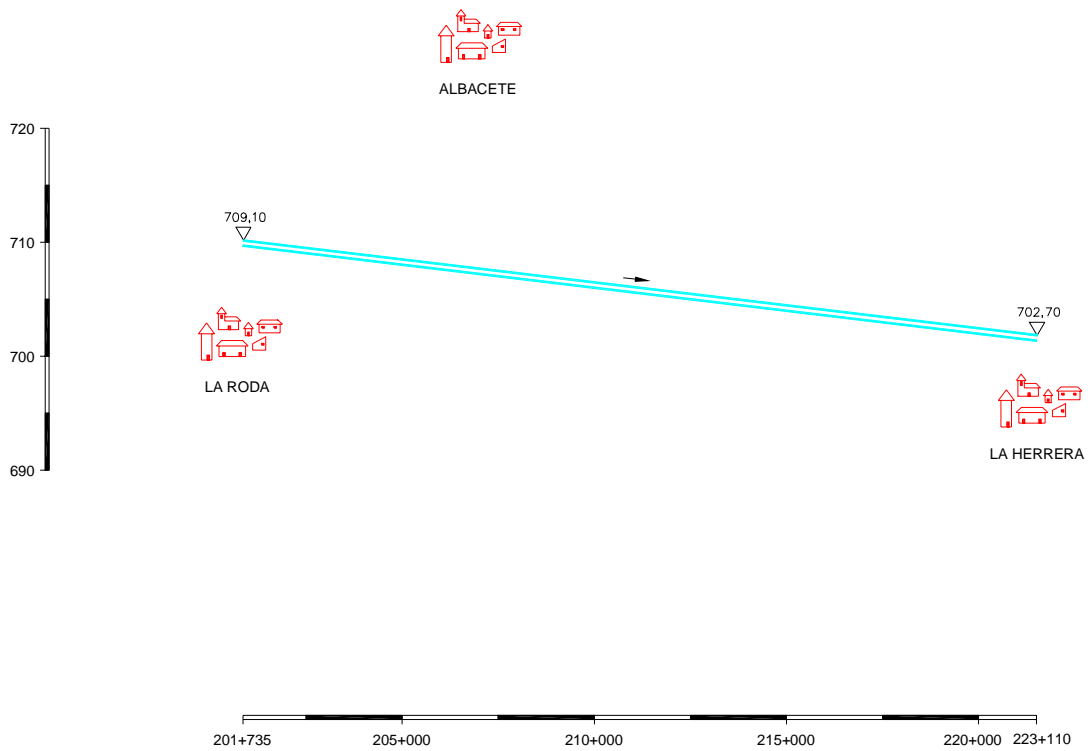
Conducción La Roda - La Herrera. Esquema en alzado
